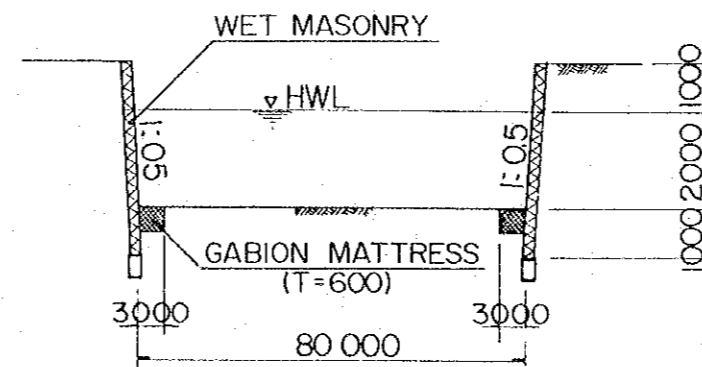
(1/2) PLAN PROPUESTO (RIO ACHIGUATE)
